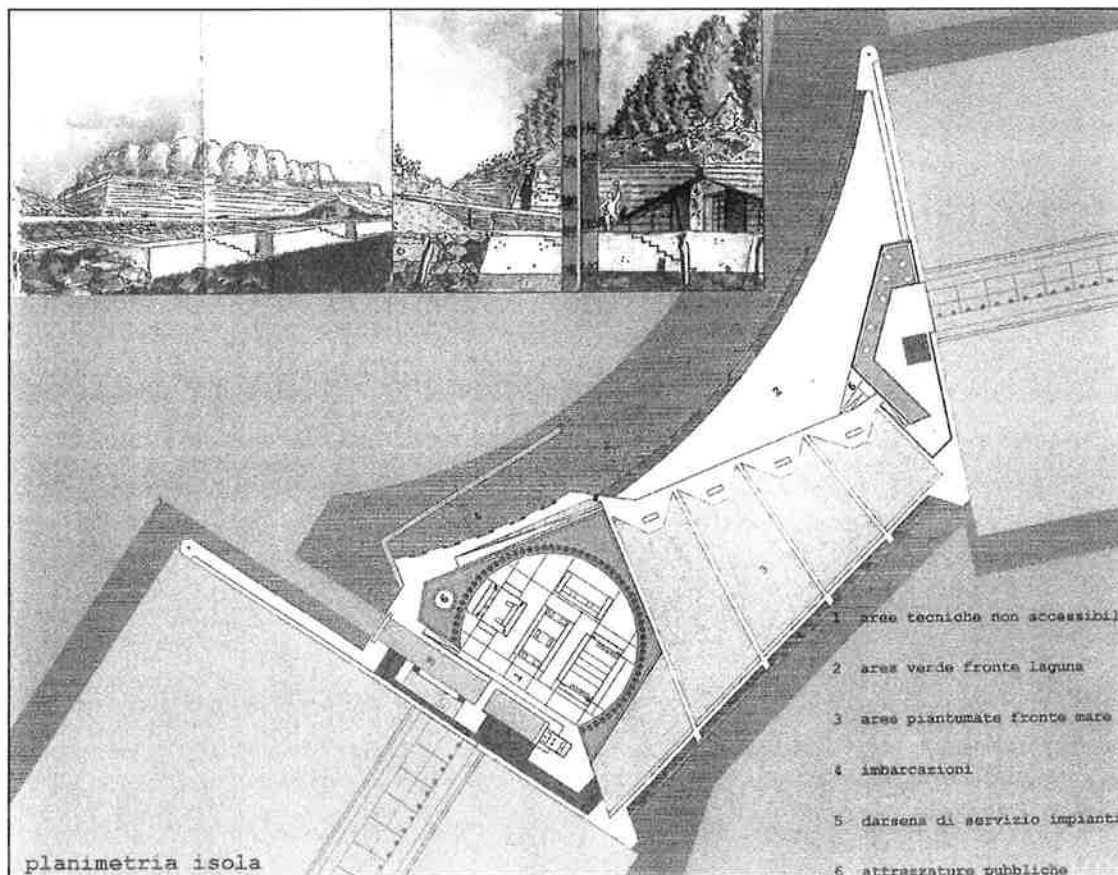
PLANIMETRIA D'INSERIMENTO PAESAGGISTICO E ARCHITETTONICO DELL'ISOLA (IUAV, 2004)
